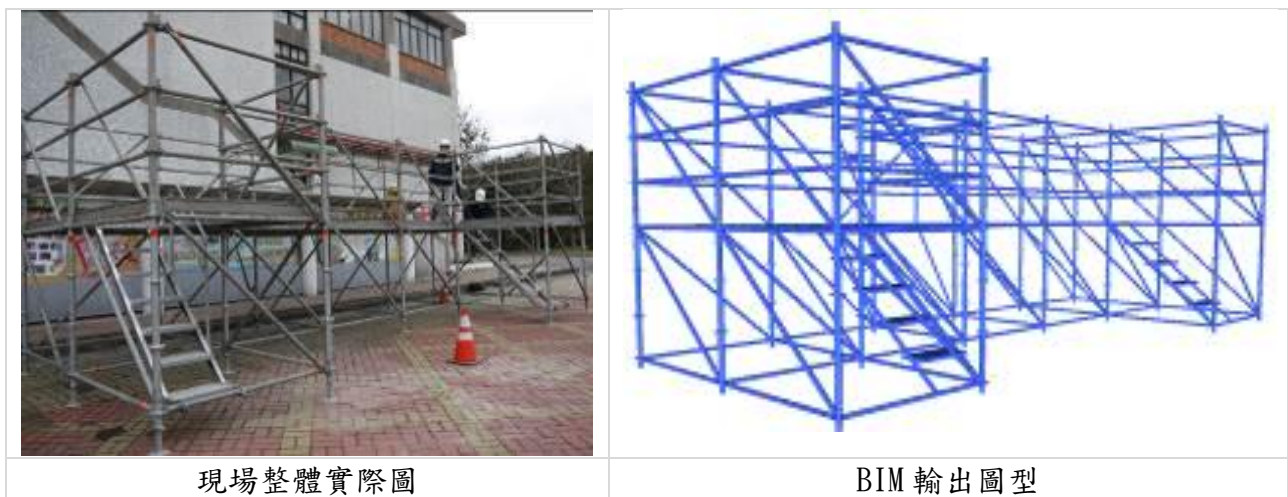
將施工安全衛生融入建築資訊模型(BIM)，以提高施工的正確性及安全性
